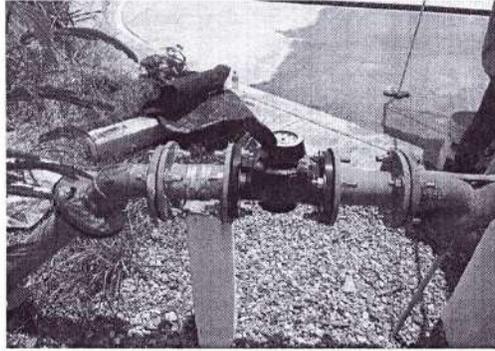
Vista general punto de captación (pozo). Fuente: Propia
